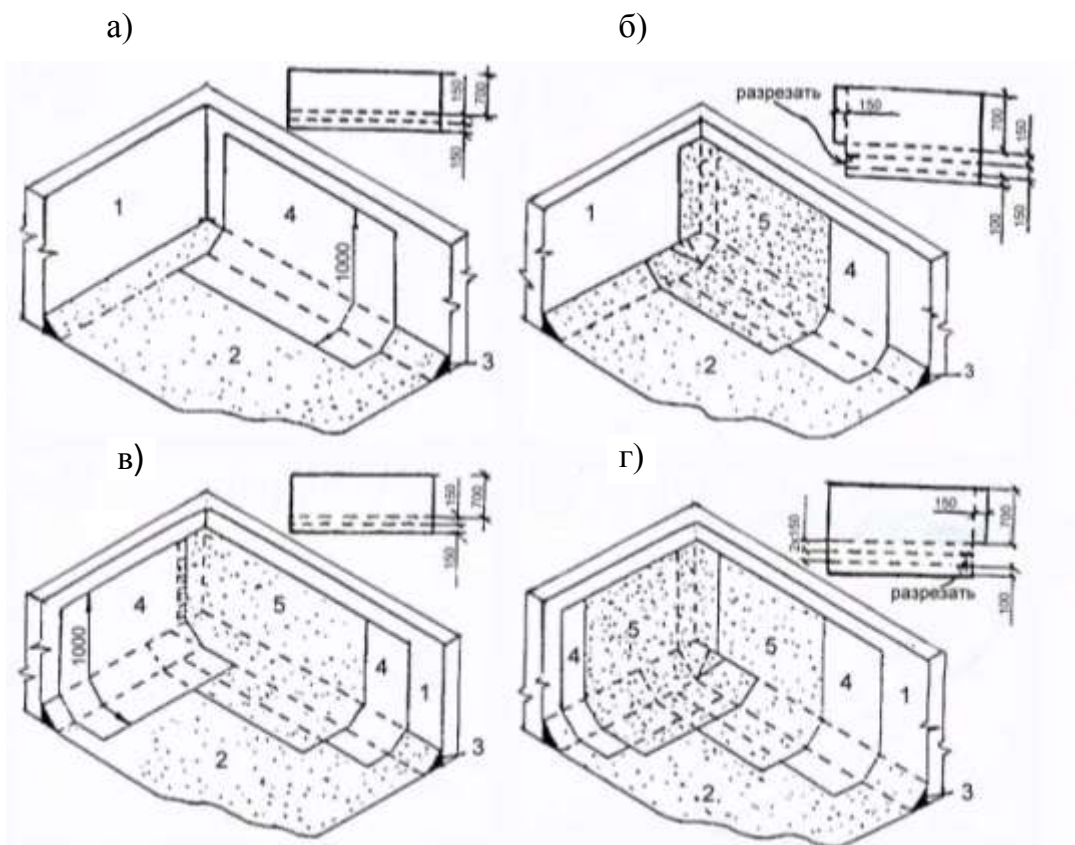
Раскладка и раскрой полотнищ наплавляемого рулонного материала при устройстве дополнительного кровельного ковра в углу парапета
